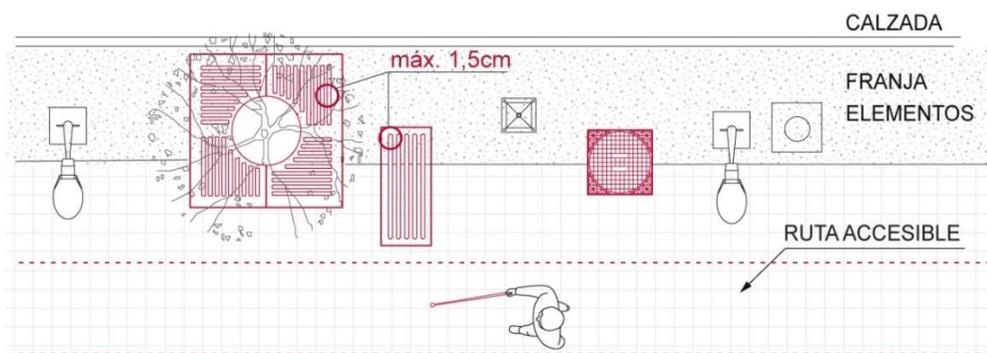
Disposición y orden de elementos tipo rejillas en la acera
